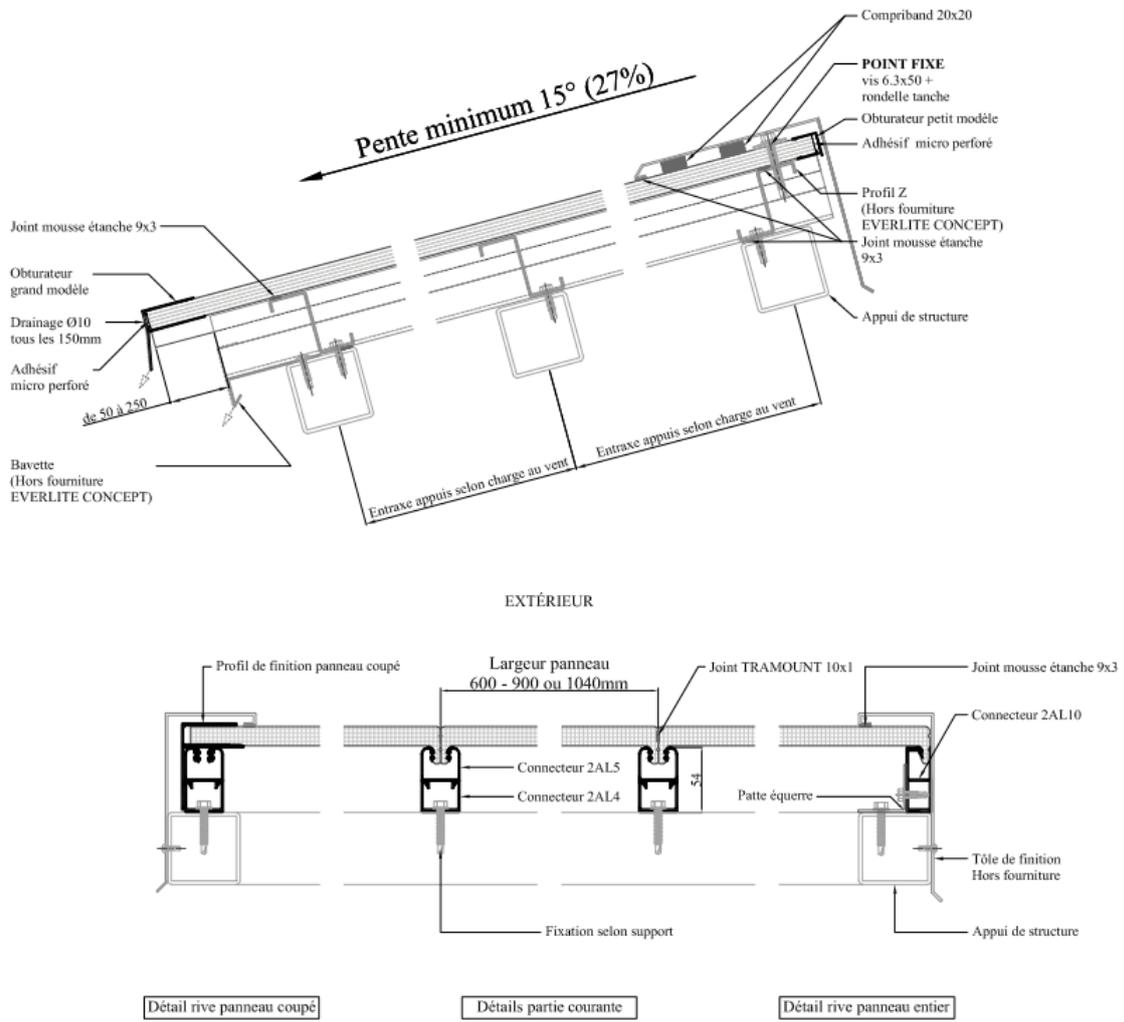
Coupe longitudinale et transversale sur connecteur aluminium 2AL4/2AL5 – Système DANPALON® Couverture Inversée
